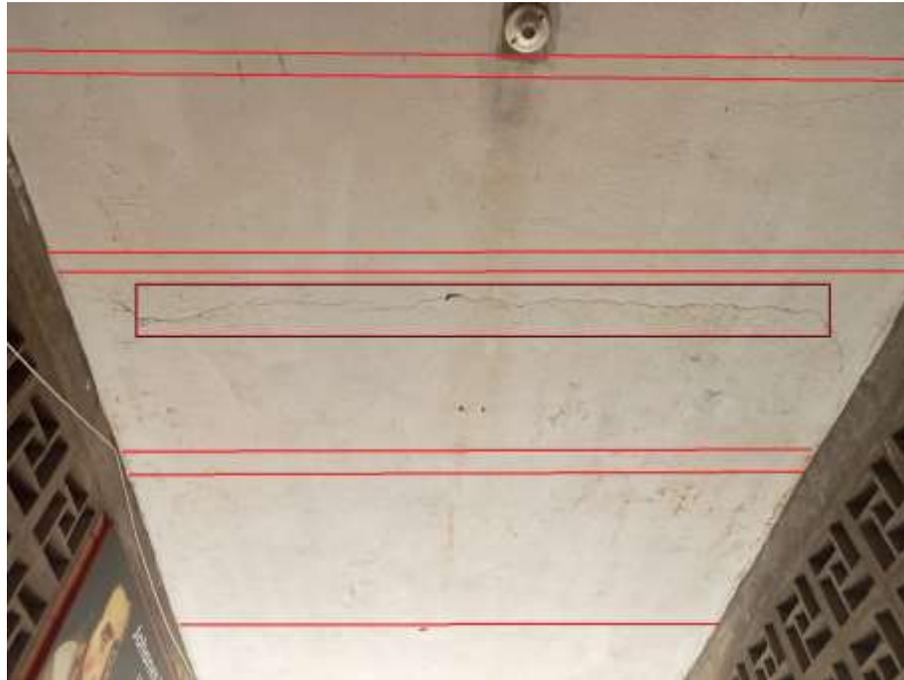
Detalle de losa aligerada – Fuente: Autor
